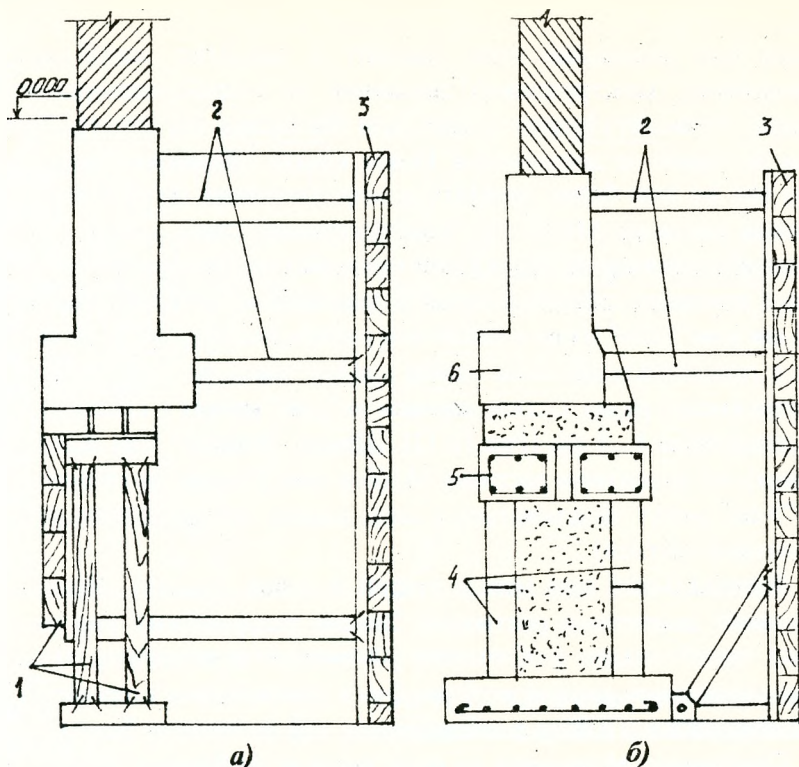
Установка крепления (а) и углубление фундамента (б).
